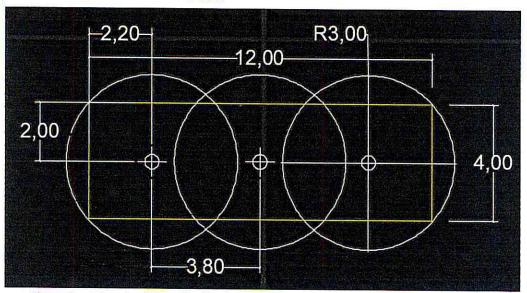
Vista de planta, distribución de los pozos para airear el área impactada A-1.
